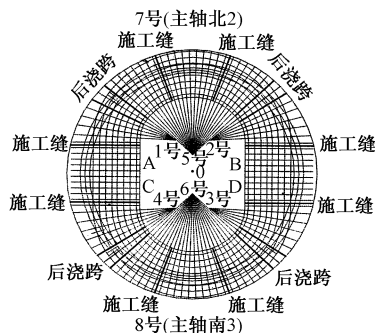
后浇跨、施工缝及平面轴线控制点位置示意
